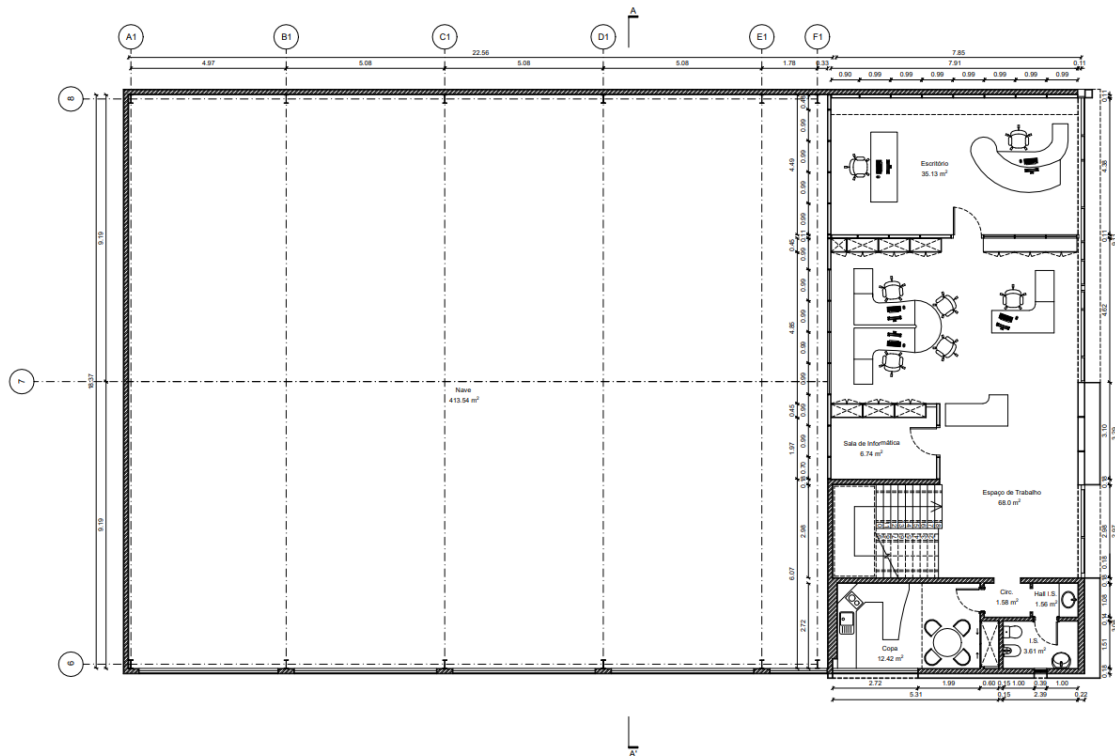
Existente - Planta piso 1. Fonte: Garq / Desenvolvimento: Autora.
